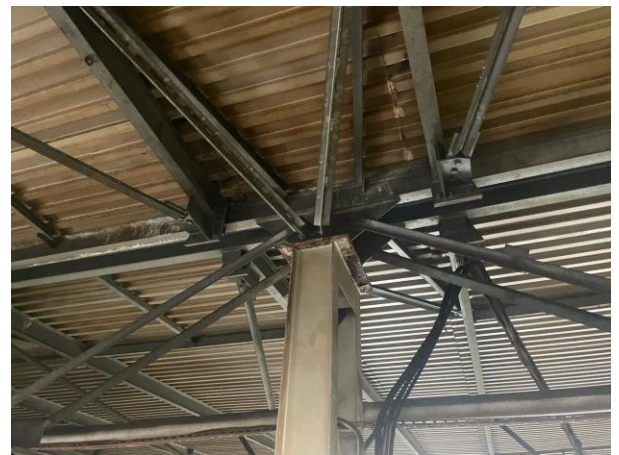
Узел опирания конструкций покрытия на оголовки колонны К2.
